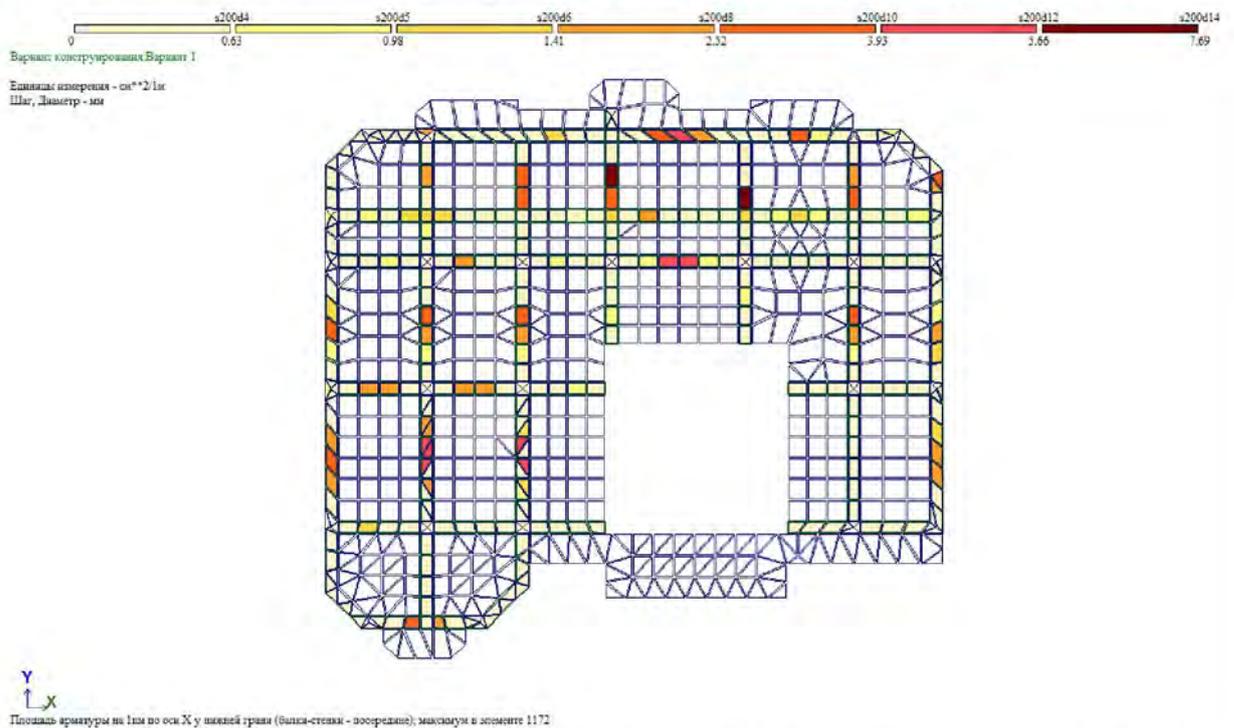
Площадь армирования по оси X у нижней грани в ребрах.
